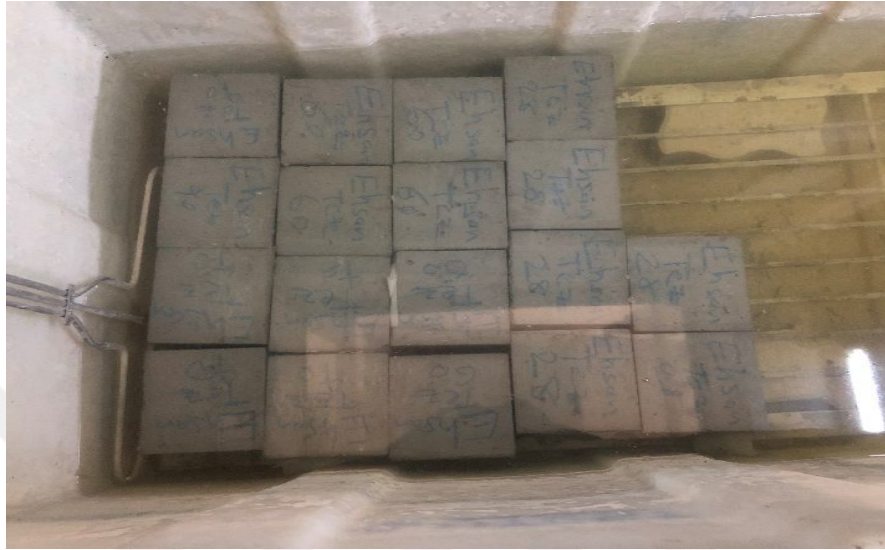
Betonarme ve salt beton blokların beton dökümü
